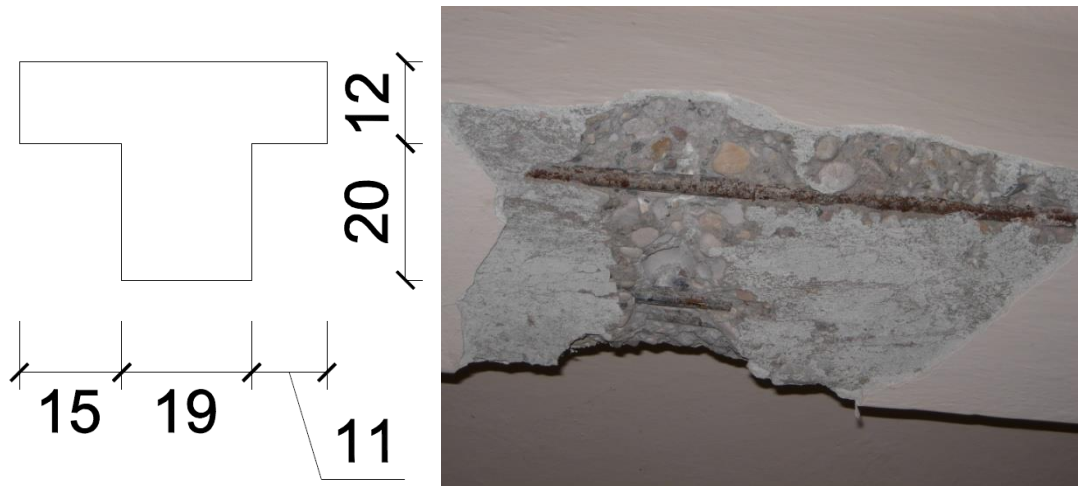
Posizioni e sezione della trave a T in C.A. rilevata
